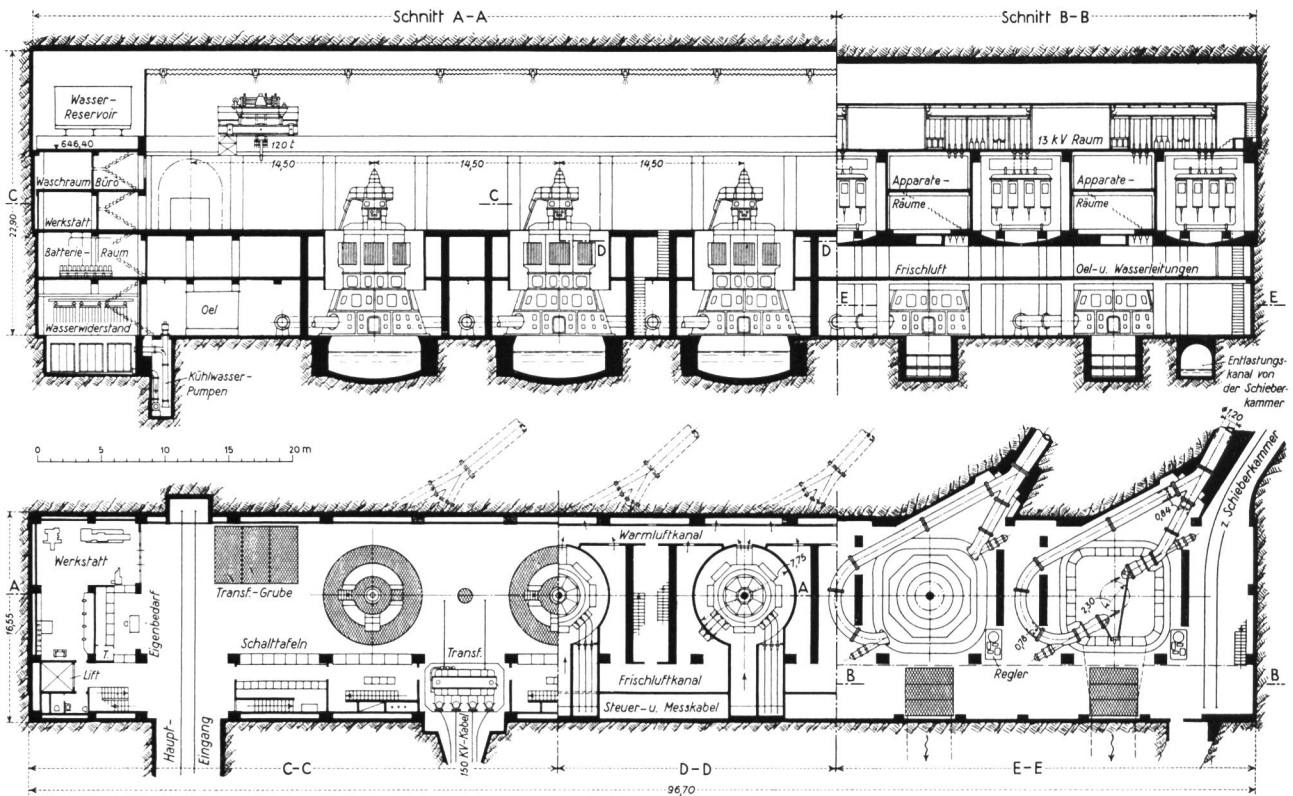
Längsschnitt und gestufter Grundriss durch die Zentralen-Kaverne Innertkirchen I.
